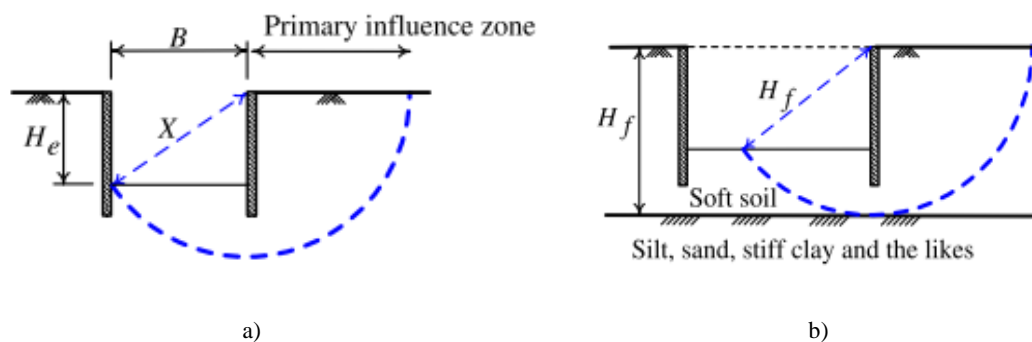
Zona de influência primária de escavações em argila mole devido ao levantamento do fundo de escavação: a) Camada de areia ou argila rija afastada; b) Camada de areia ou argila rija próxima (Ou & Hsieh, 2011)
